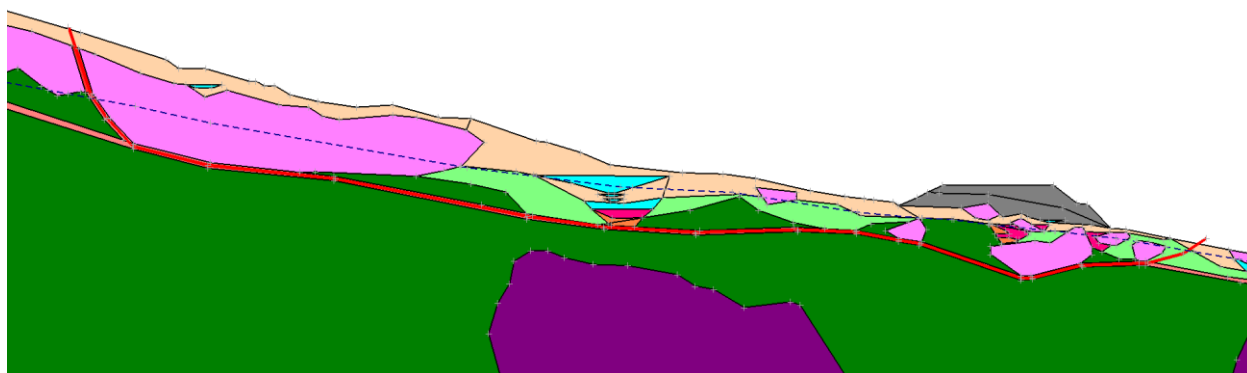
Detail výpočtového profilu 1, varianta s násypem.
